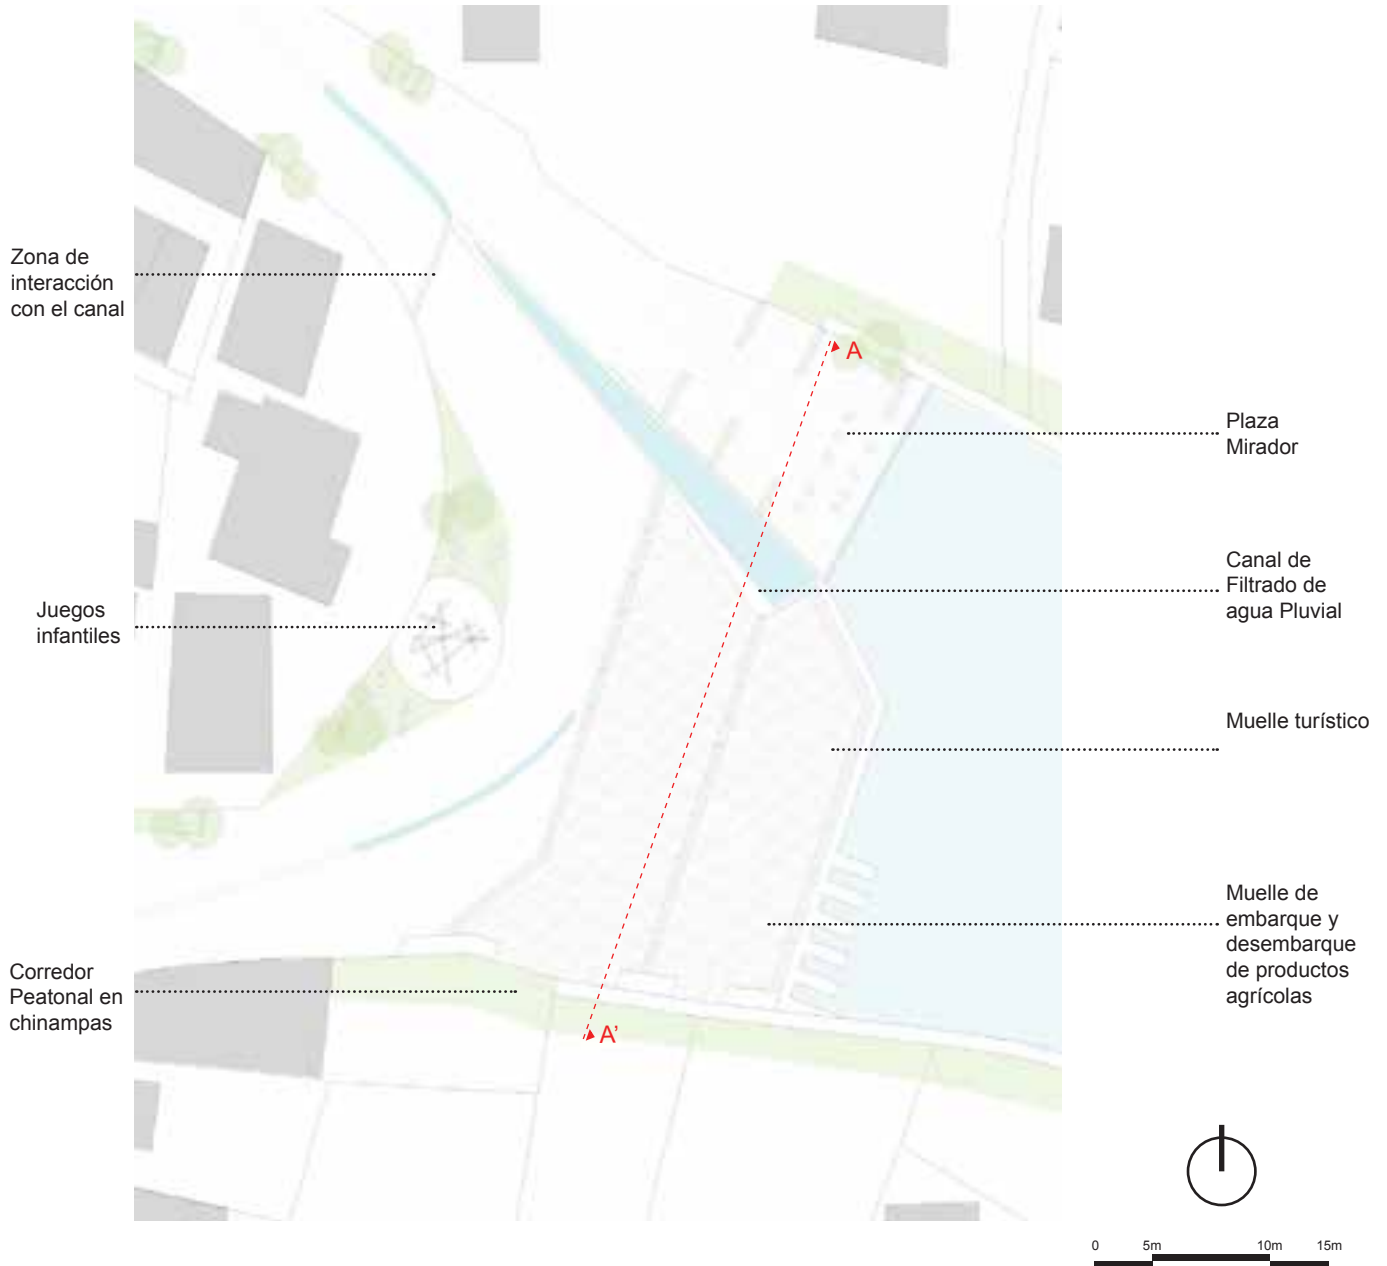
Planta del embarcadero y mirador del proyecto.
